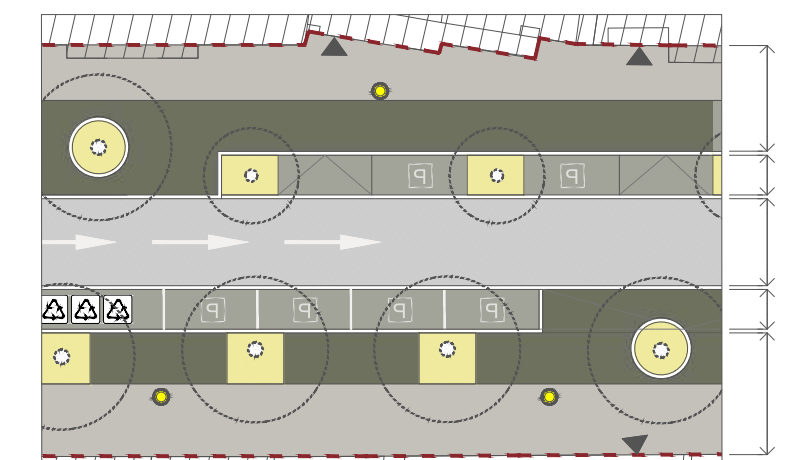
Vista a partir do passeio do lado poente da rua: espaço pedonal com bandas de pavimento liso (circulação universal) e zona de estadia/ de sentar; espaço da arborização com alinhamentos laterais de árvores de copa muito larga, propostas e existentes (*Platanus x acerifolia*), em faixa contínua (com bordadura mista de subarbustos e herbáceas vivazes); espaço viário com uma via de trânsito (sentido norte-sul) e zona de estacionamento que tira partido do espaço da arborização.
